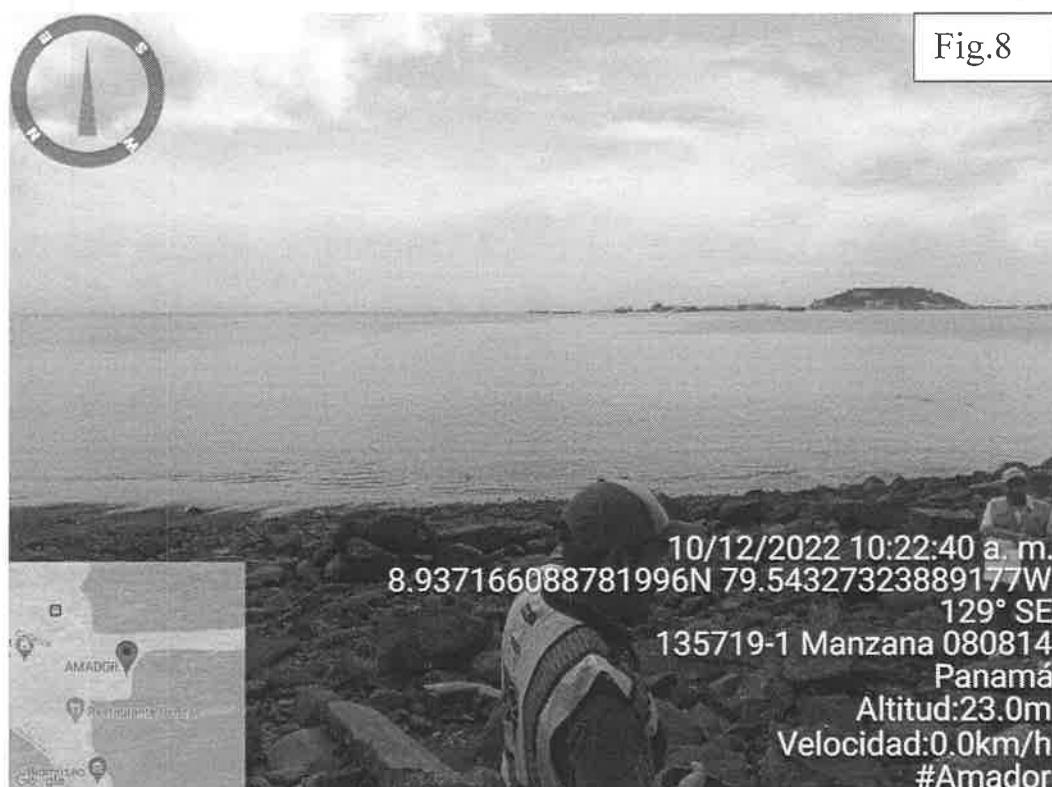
Área marina que será conformada y estabilizada para las estructuras de muelles y rampa con material excedente procedente del dragado.
